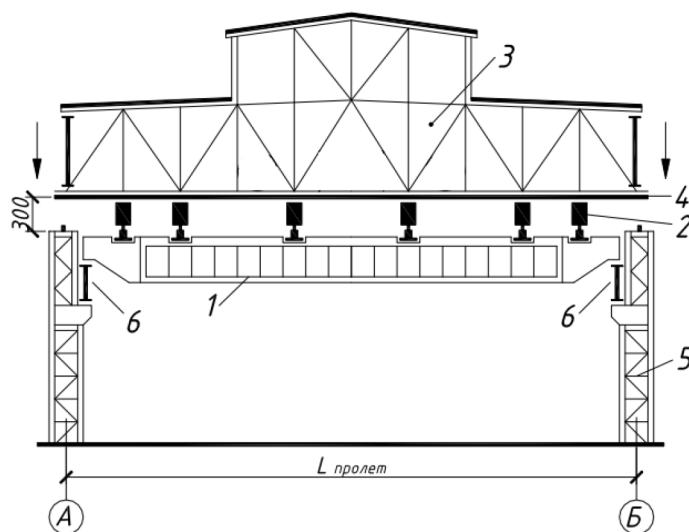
Схема монтажа блоков покрытия низким установщиком: 1 – низкий установщик;
